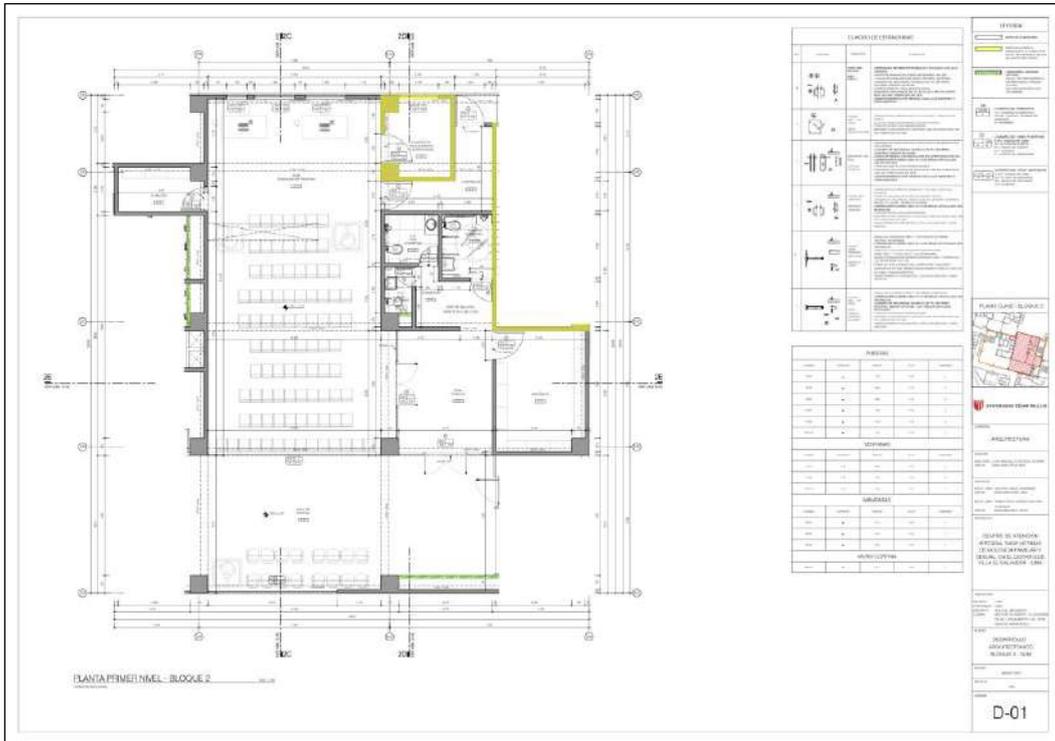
Planta primer nivel de zona SUM – bloque 2.
